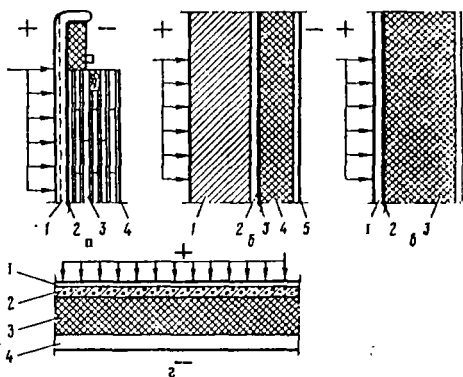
Схема расположения паронзоляции в строительных конструкциях:
